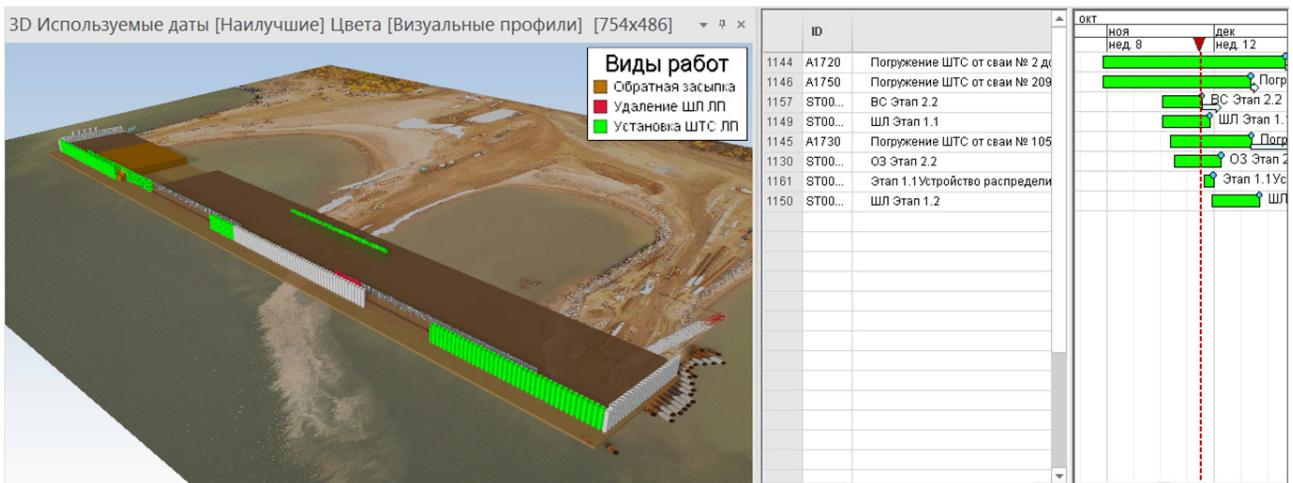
Отсыпка насыпи до отм. -2,500, погружение свай лицевой стенки, демонтаж временной стенки из шпунта Ларсена, погружение шпунта Ларсена в проектное положение
